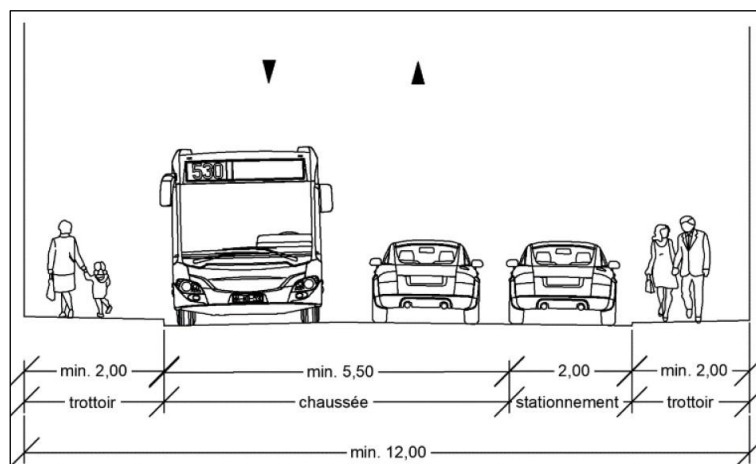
Coupe en travers de l'avenue Gorges Henri (source : AGORA)
